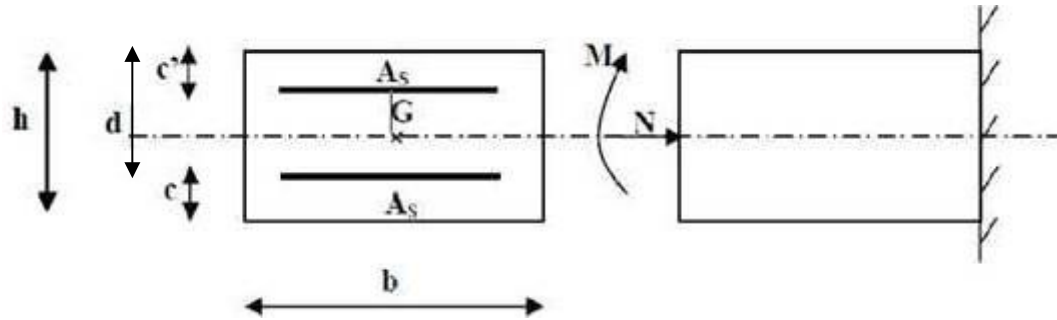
Schéma statique de la section de l'acrotère.
